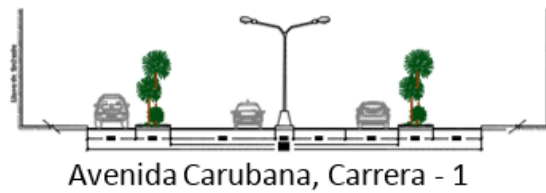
Perfil vial propuesto. Colectora. Fuente: Flores y otros. (2018)
